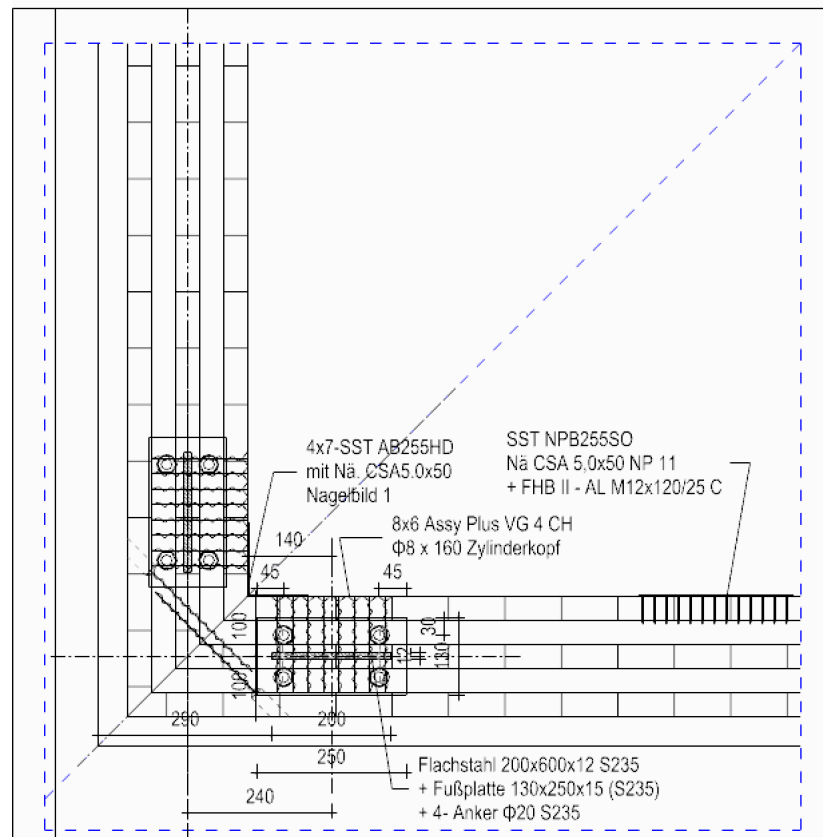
[ Schnitt - 4 ] M 1:10
